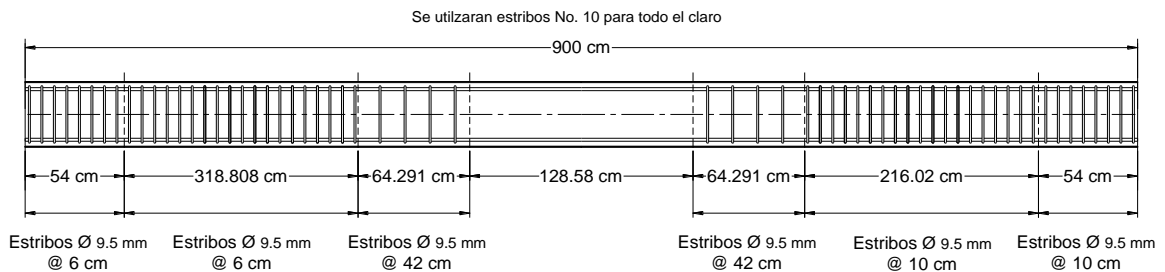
Distribucion del acero de corte en el elemento numero (8373).
